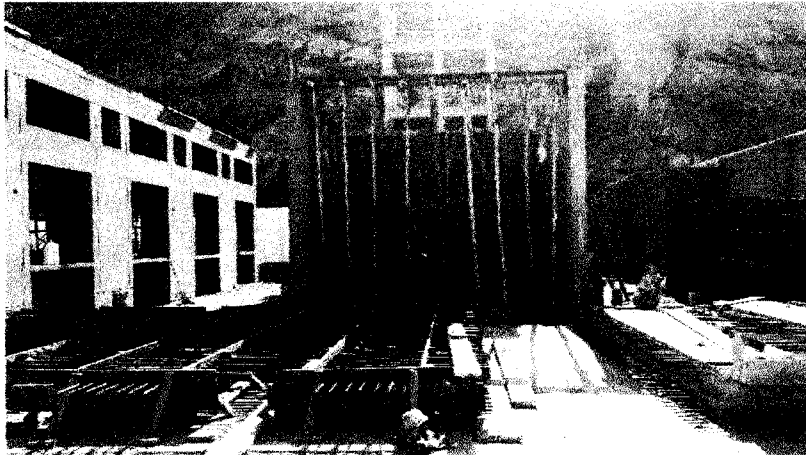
Encofrado de losa aligerada en la zona de Maestranza.
